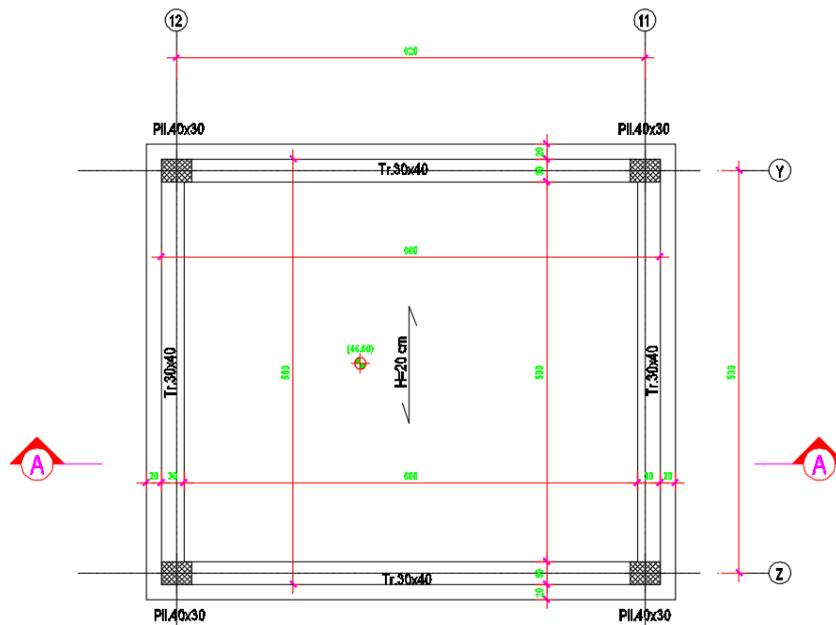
Locale pompe di rilancio – Vista Planimetrica
